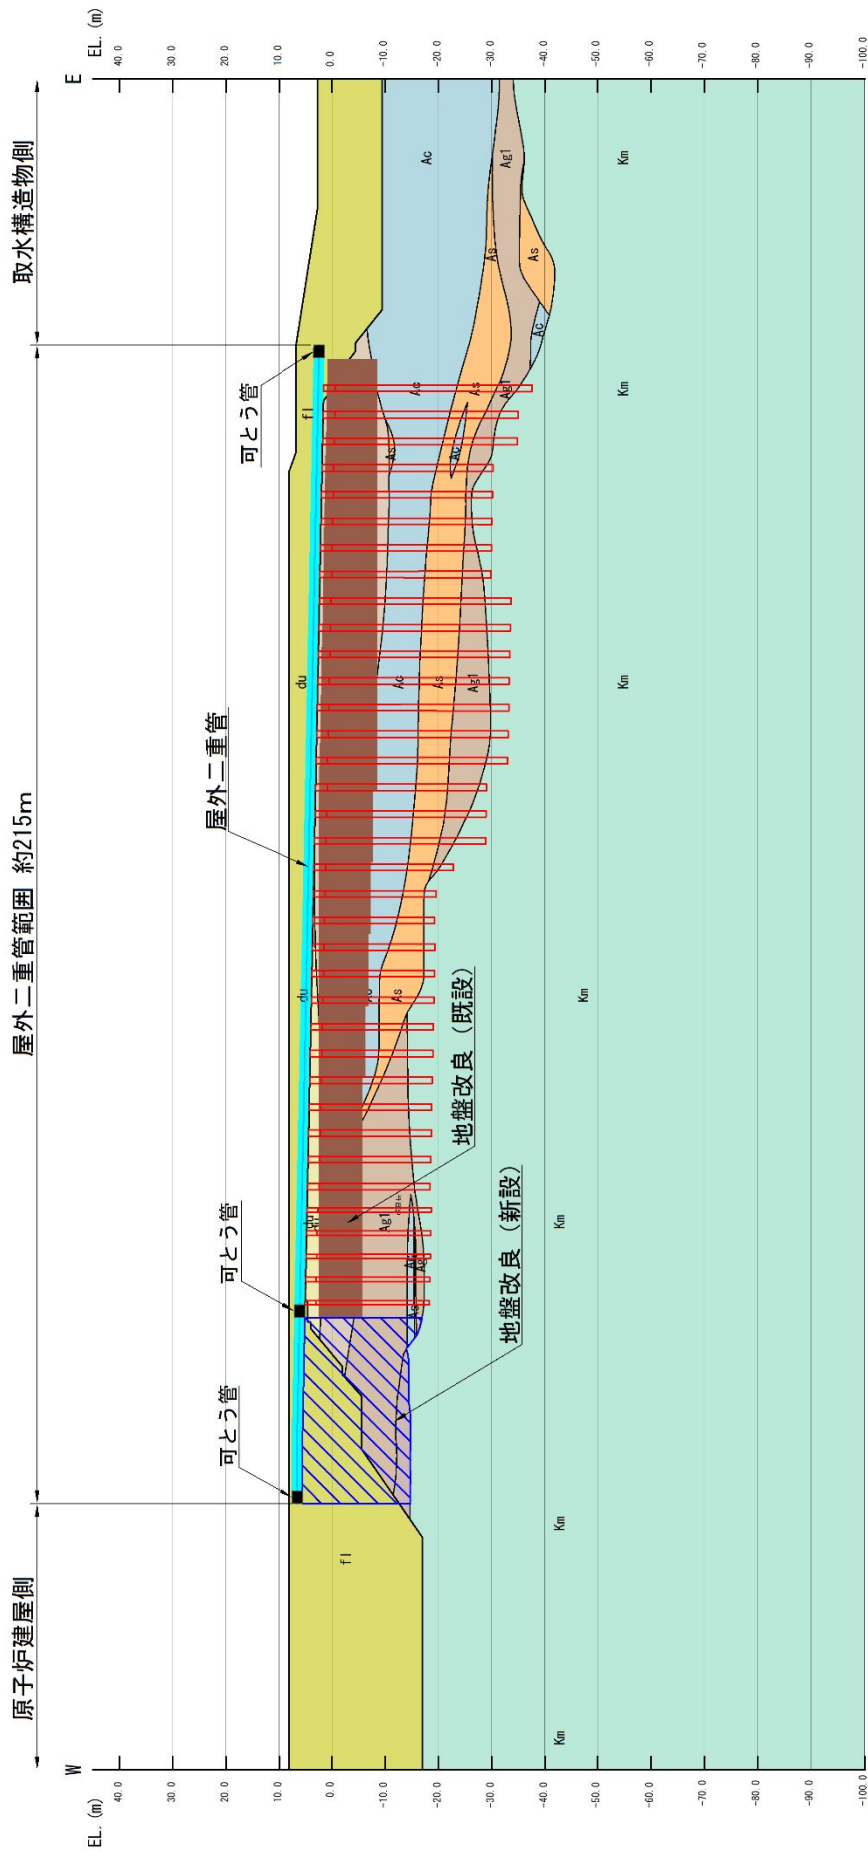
(1) 屋外二重管の縦断面図 (A-A断面)
